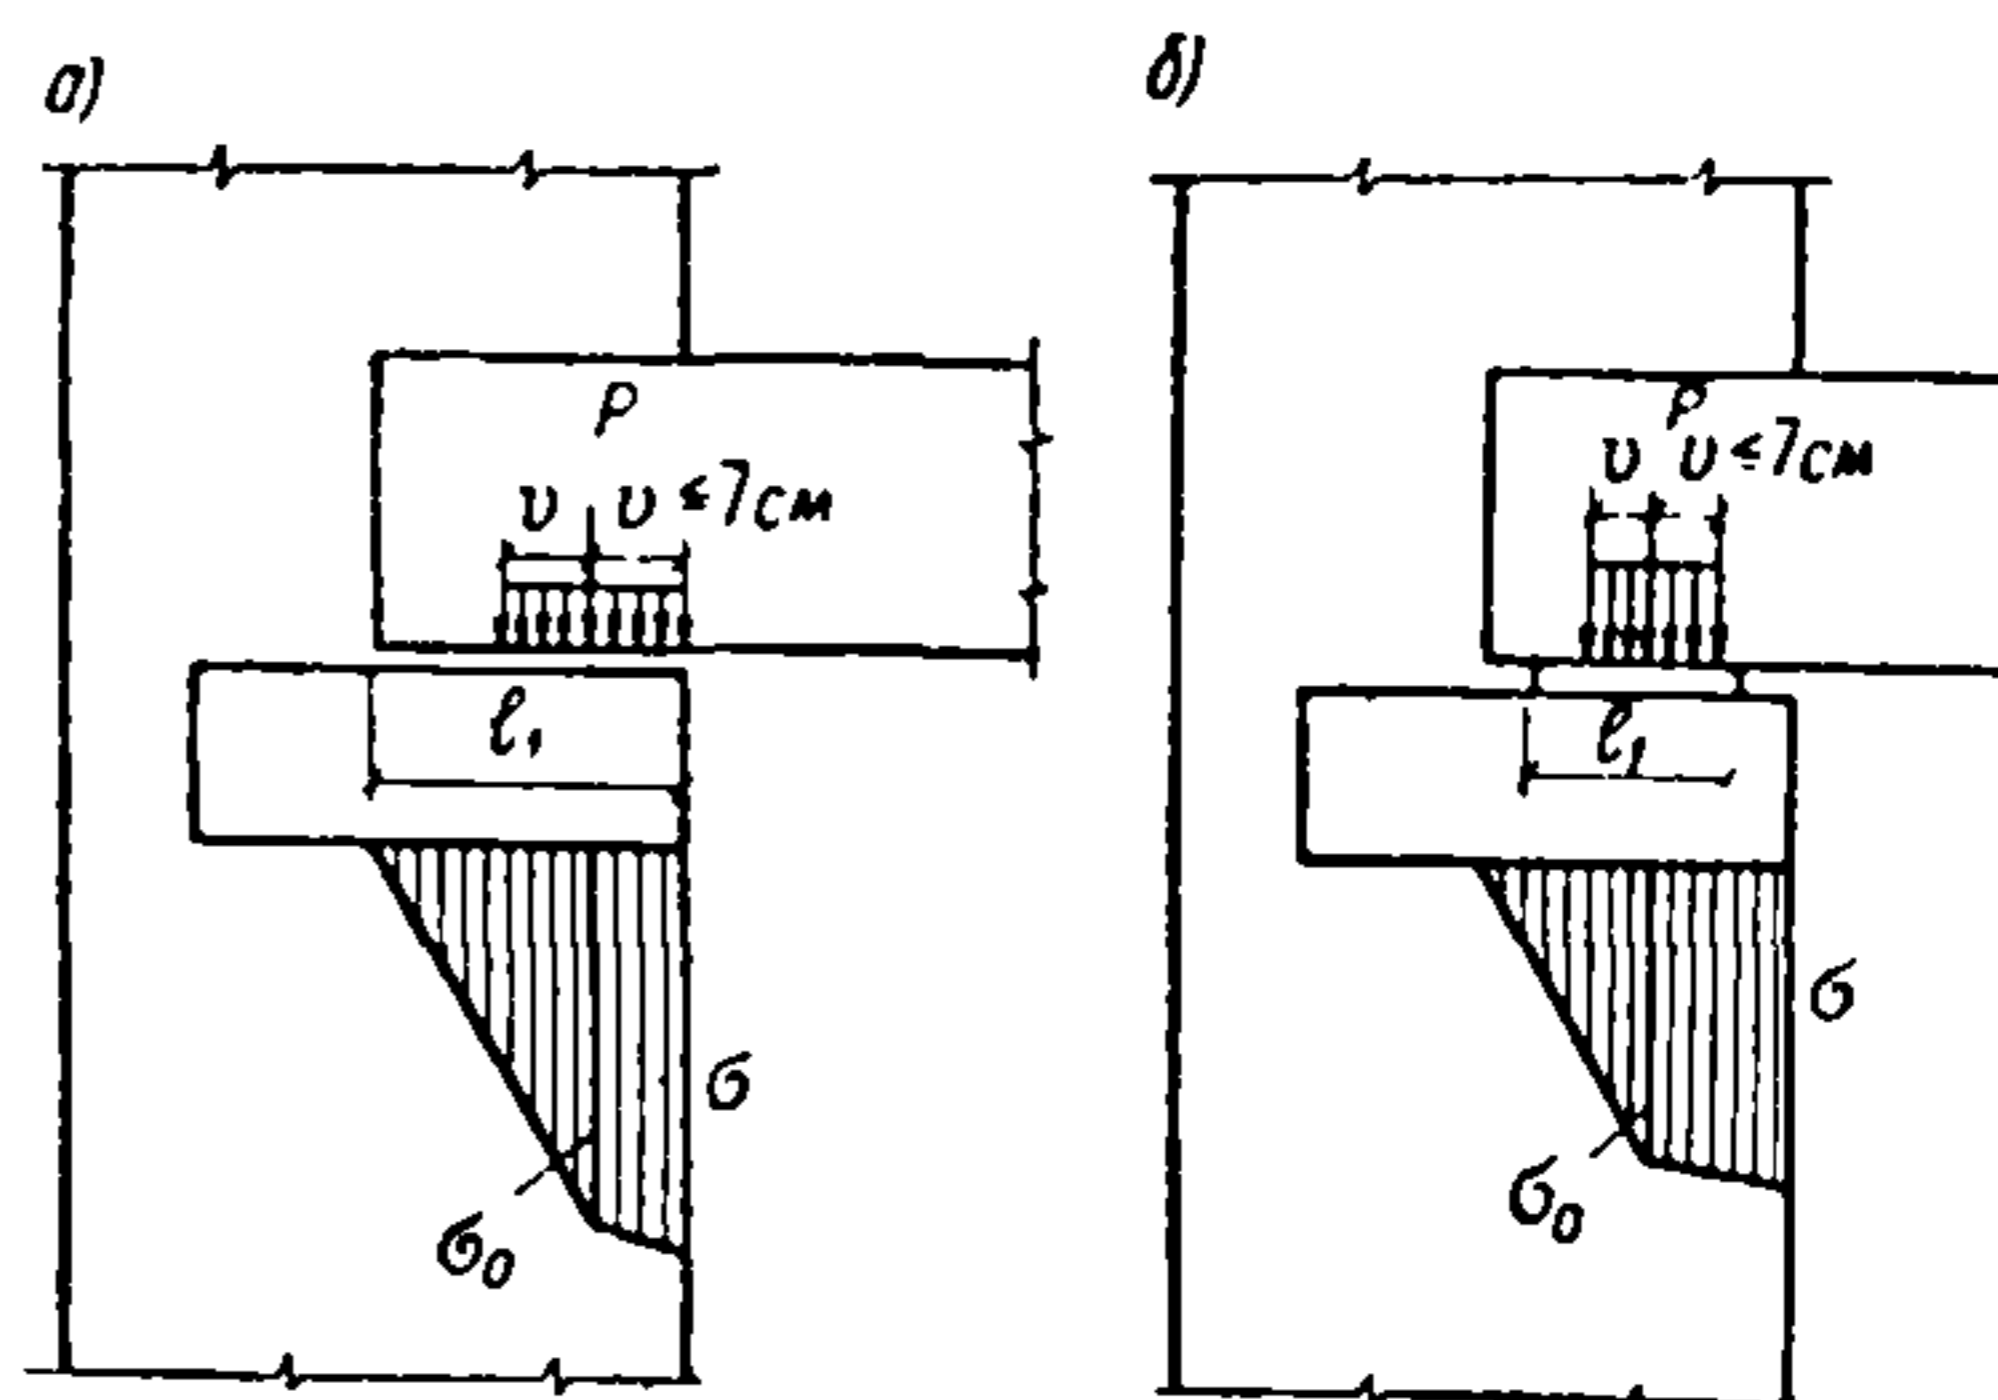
Схема нагрузок и напряжения при расчете опорной плиты
